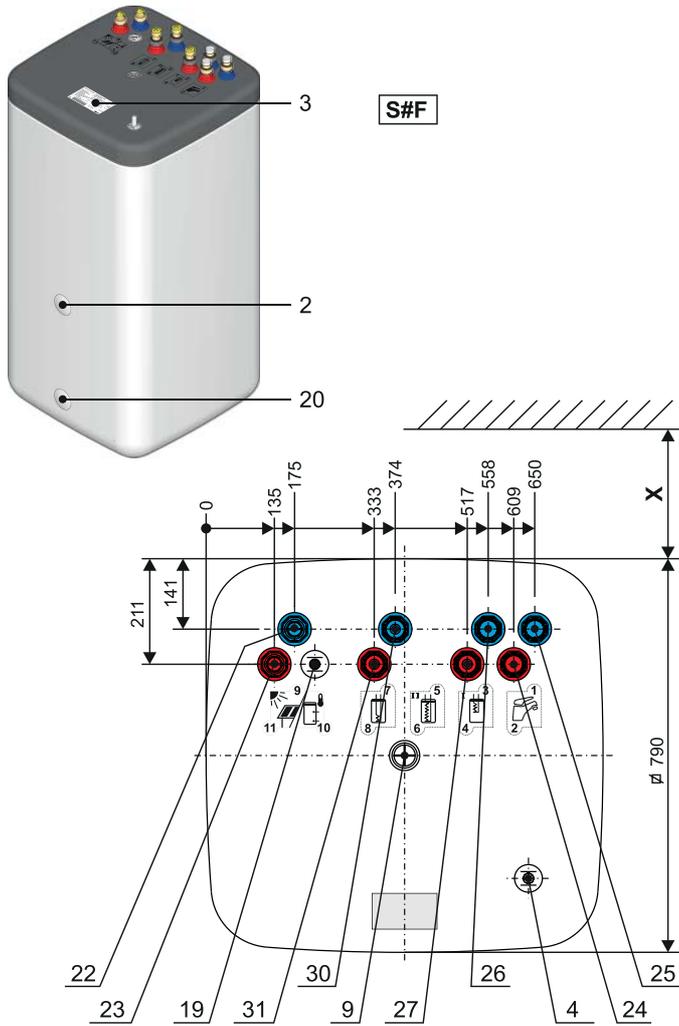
Collegamenti e dimensioni, Bollitore ad accumulo ad alta prestazione con supporto solare -  tipo EKHWP 300/500B-DB
